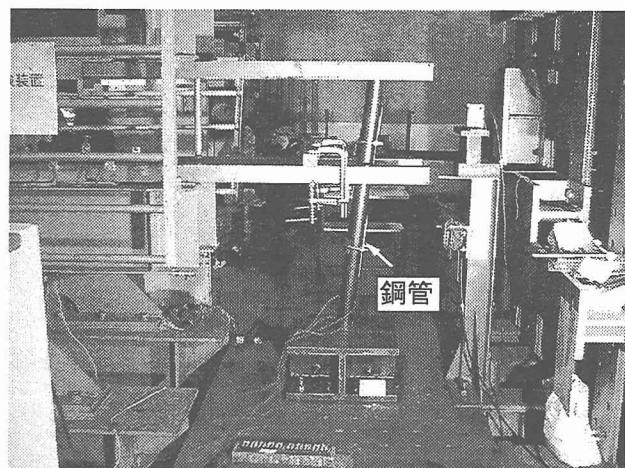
鋼管 2.5m/s の1回目衝突終了後の状況
